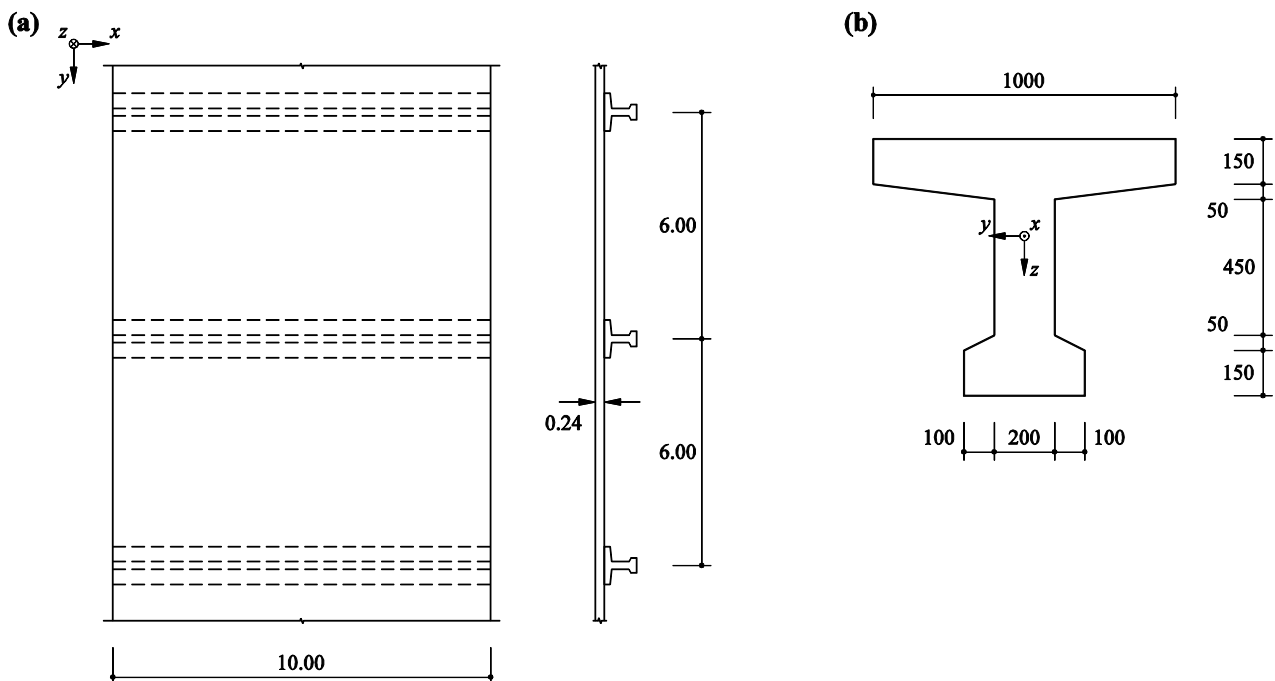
(a) Grundriss und Querschnitt der Deckenkonstruktion (Abmessungen in m); (b) Querschnitt des Balkens (Abmessungen in mm).
